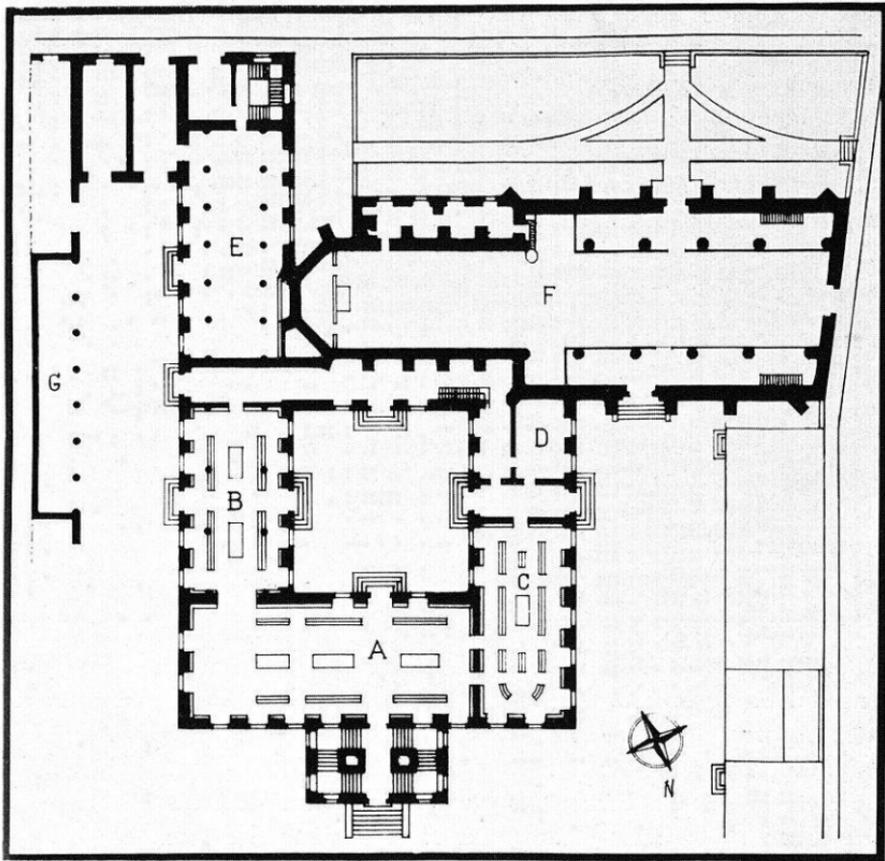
Erdgeschoß des Kollegienhauses nach dem Erweiterungsbau 1784
